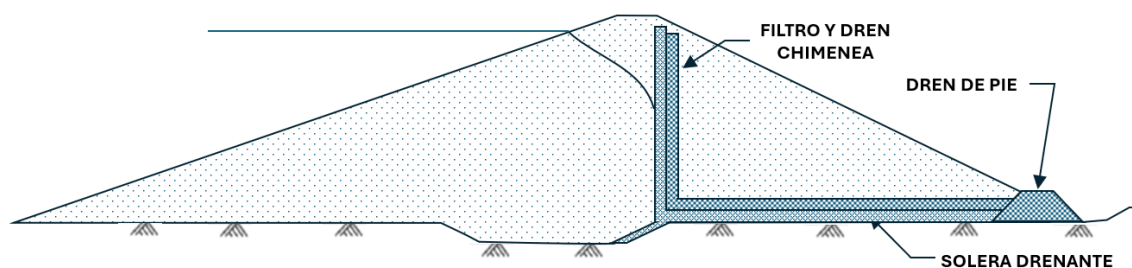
Sección homogénea modificada con dren chimenea, solera drenante y dren de pie.
